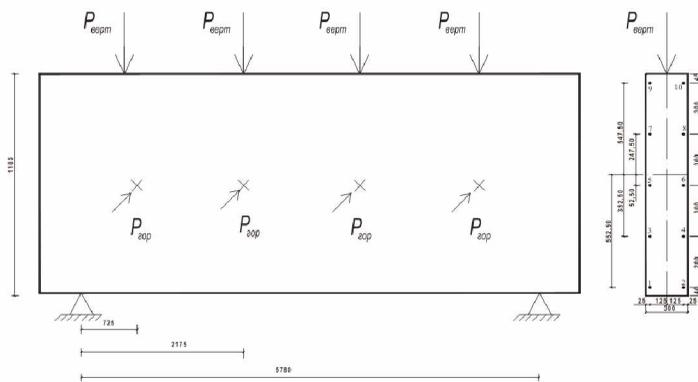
Схема испытания однослойной стеновой панели на совместное действие вертикальной и горизонтальной нагрузок ПС 600.12.30 (армирование панели класса А400 10 Ø6мм)
